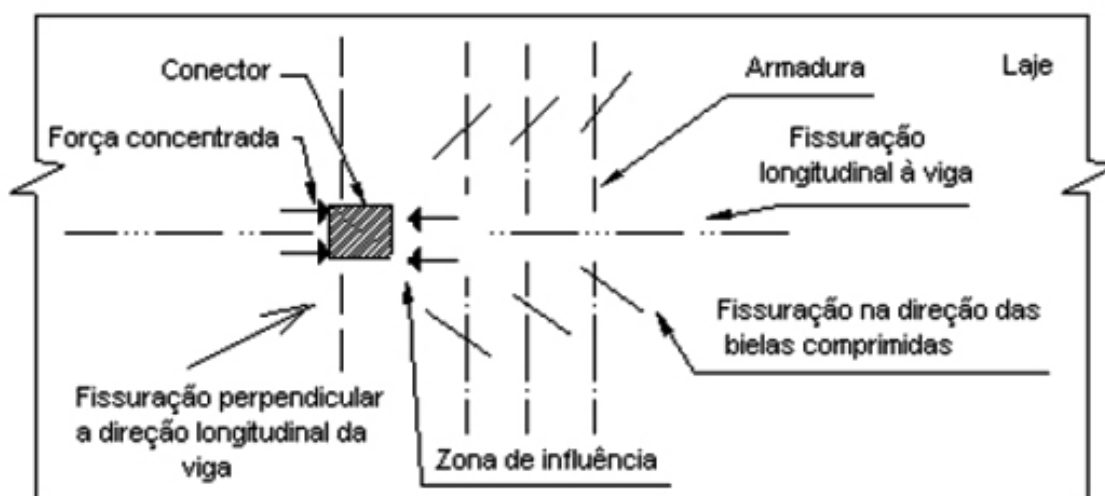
TIPOS DE FISSURAÇÃO NA LAJE DEVIDO À FORÇA CONCENTRADA
